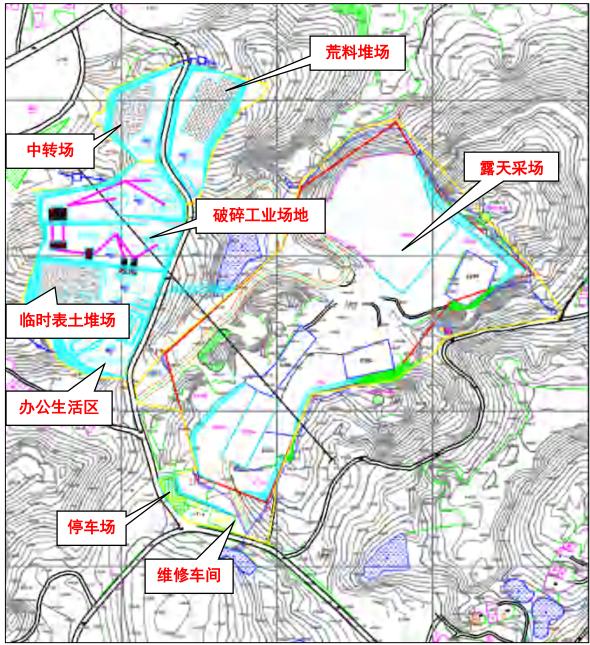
矿区总平面布置及基建终了平面图(来源:《开发利用方案》(修编))
